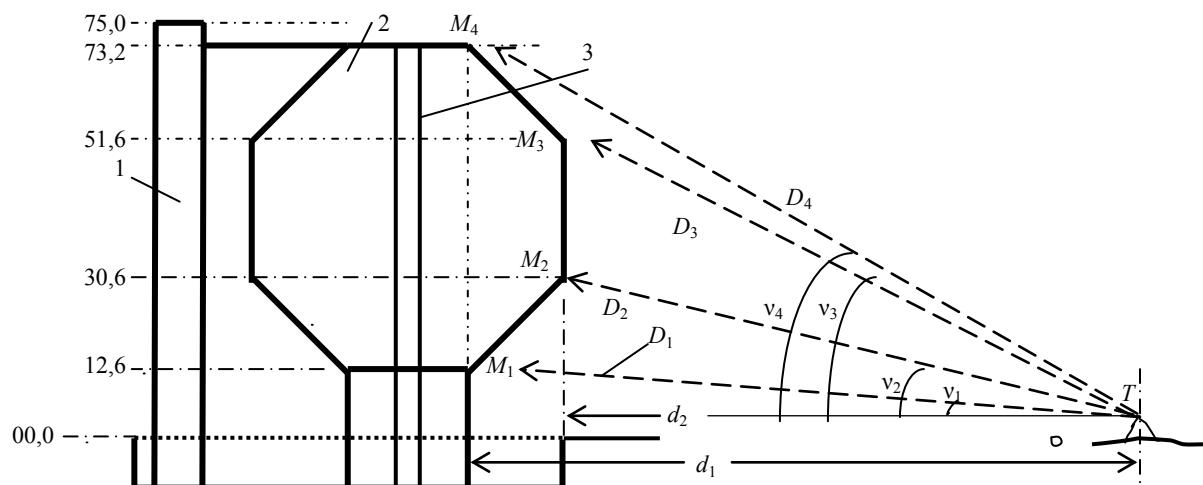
Проект схемы наблюдений деформационных точек на здании высотного книгохранилища Национальной библиотеки Республики Беларусь: 1 – лифтовая башня; 2 – высотное книгохранилище; 3 – ядро жесткости; T – тахеометр; M_1, M_2, M_3, M_4 – места деформационных марок; v_1, v_2, v_3, v_4 – углы наклона; D_1, D_2, D_3, D_4 – дальности
